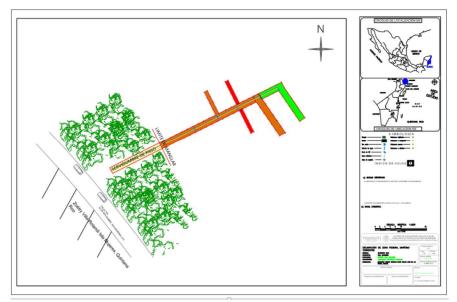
d. Plano del proyecto señalando las secciones sometidas a evaluación.
